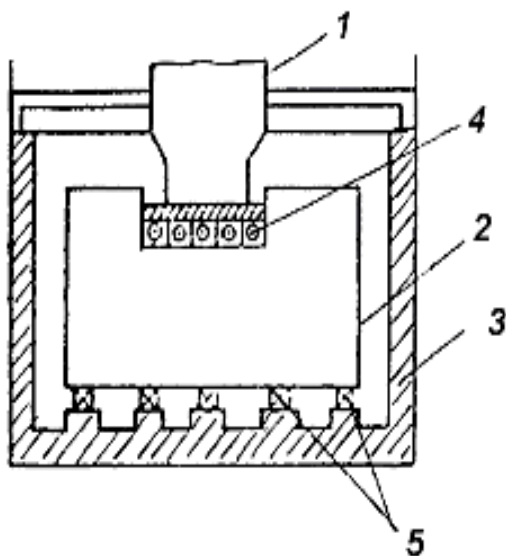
Схема вибро-изоляции фундамента под штамповочным молотом:
